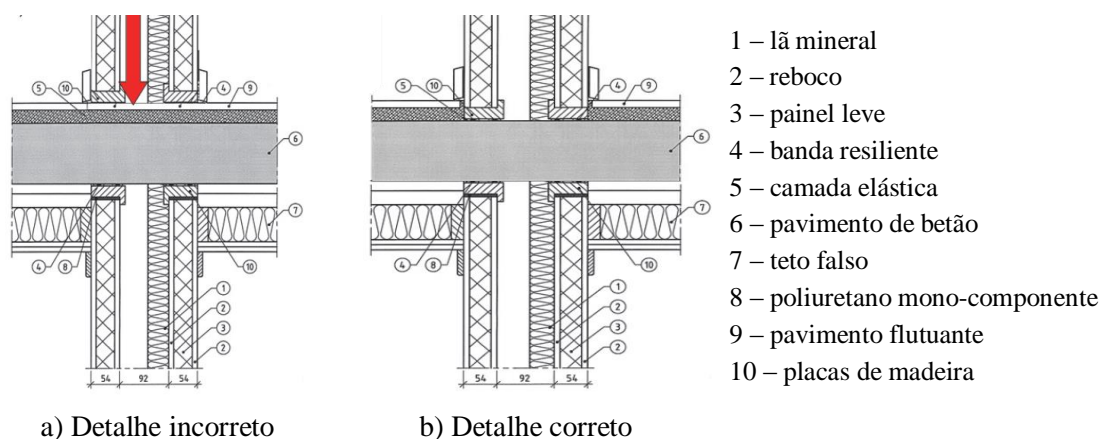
Parede leve de estrutura metálica (COST, 2014)
